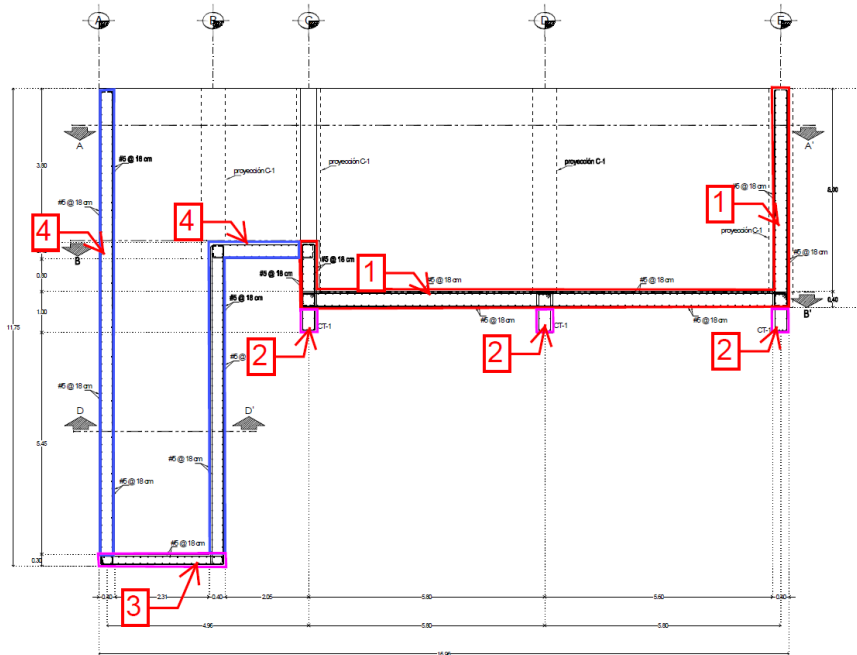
Arreglo de cimentación de las bombas de pozo caliente (Vista en planta)
